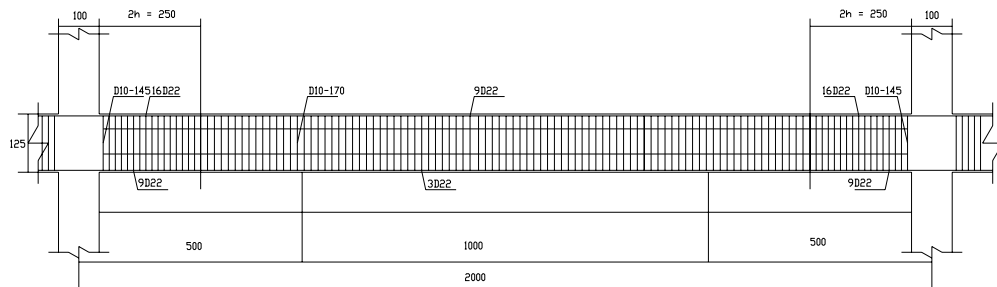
Detail penulangan balok induk 80/125 (cm) lantai 2 model
